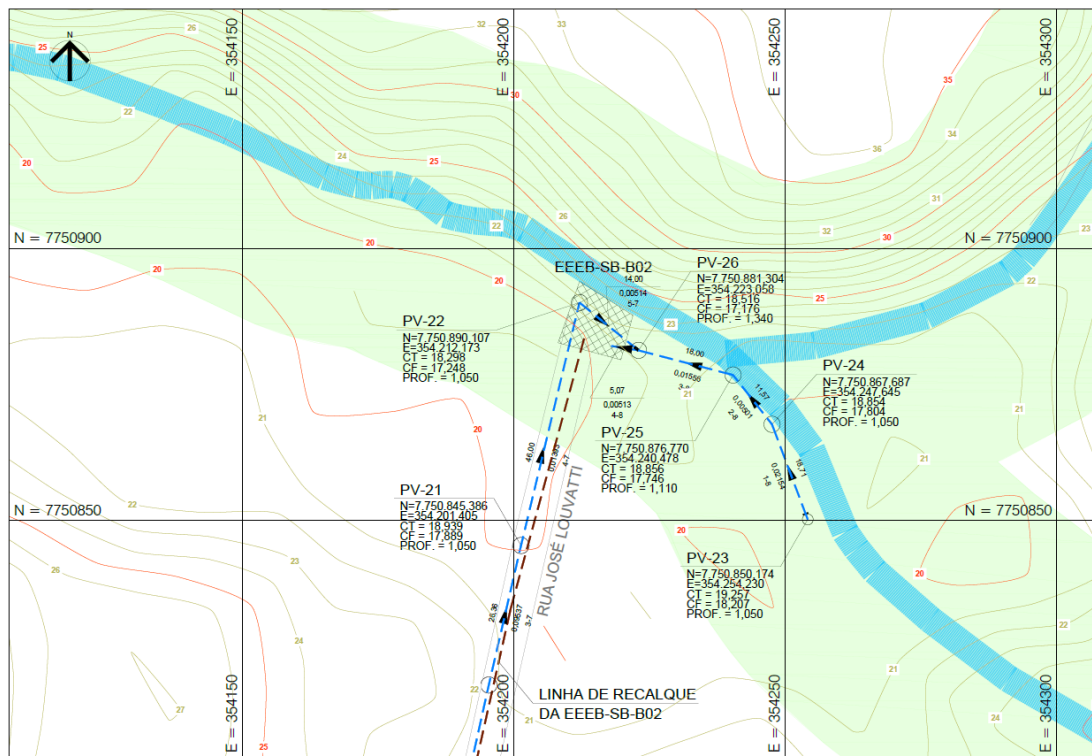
Estação elevatória de esgoto bruto EEEB-SB-B02, em área de APP.
